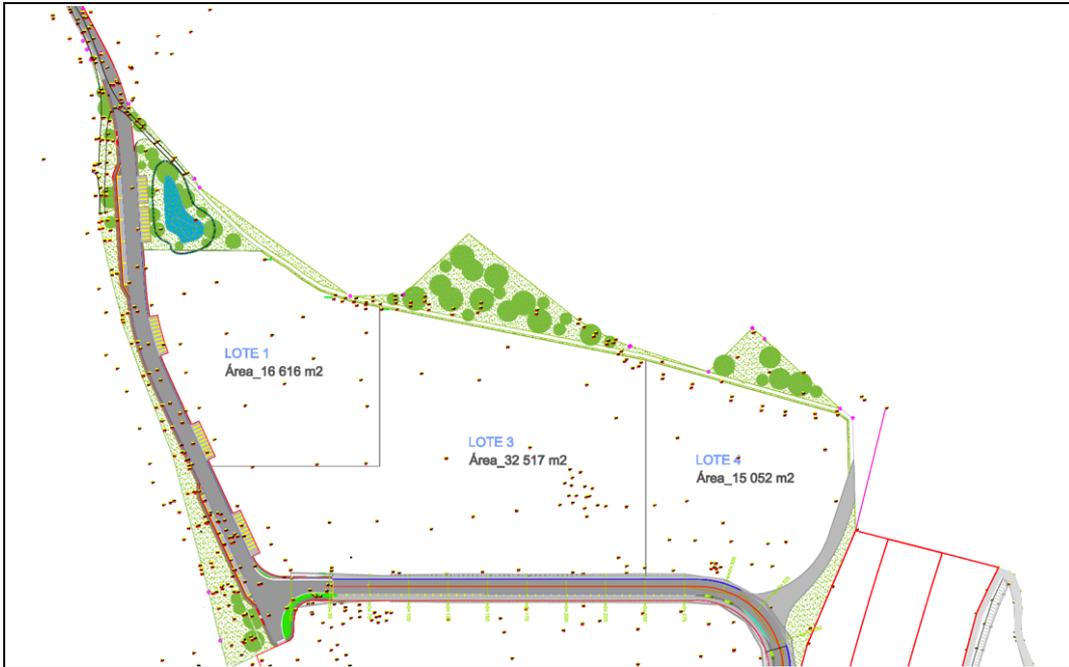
Loteamento n.º 1 da Zona Industrial do Montalvo.
